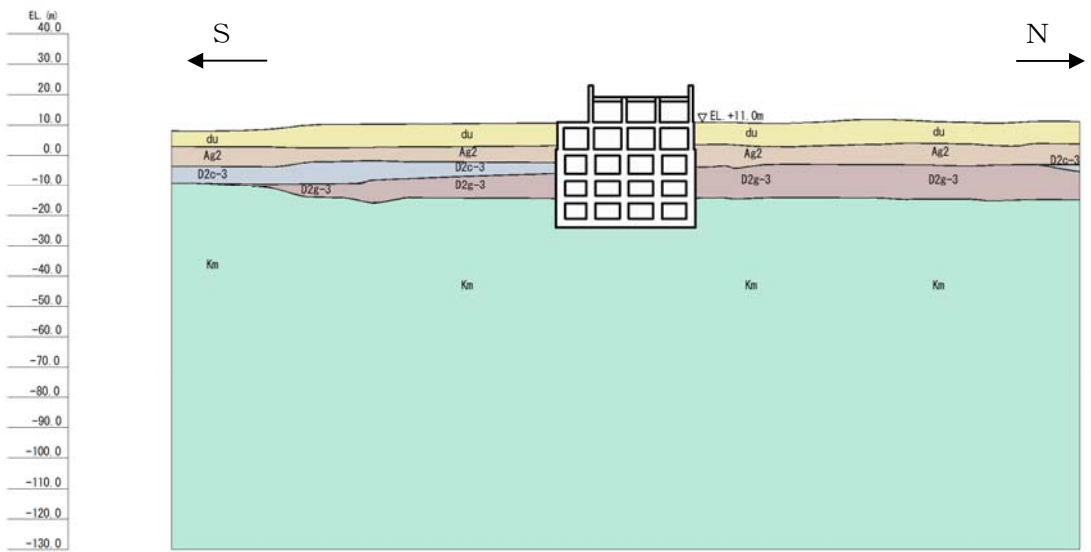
(1) 地質断面图 (南北方向⑤-⑤断面)
